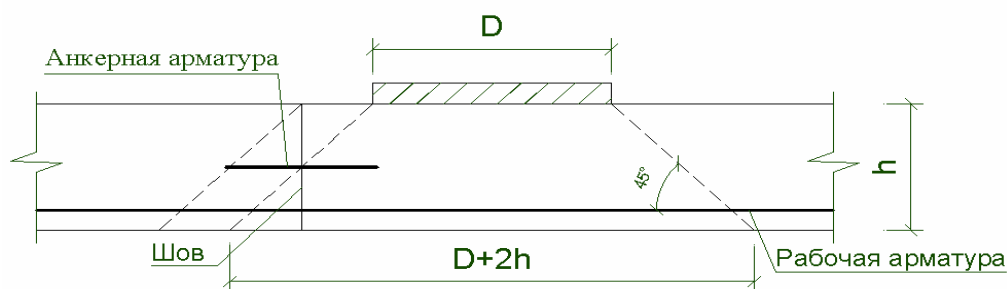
Схема распределения нагрузки для плит жесткого дорожного покрытия
